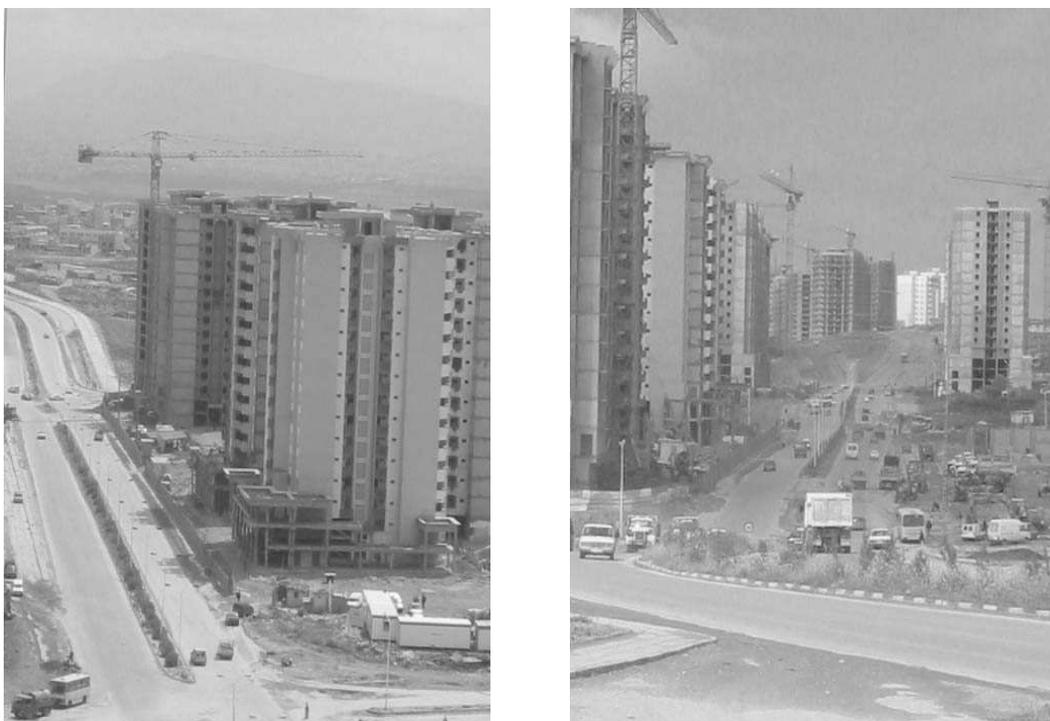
& 24 : Immeubles location-vente longeant le boulevard principal
